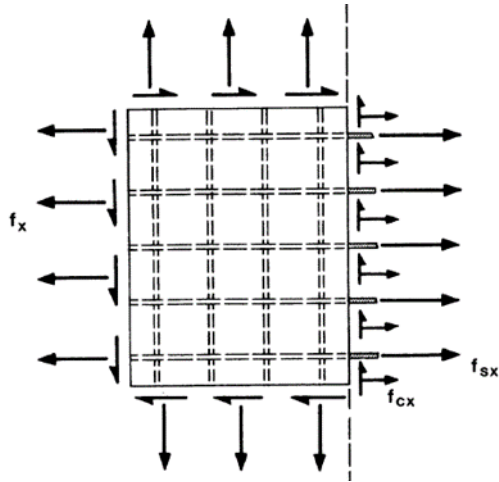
Painel fissurado de concreto armado (VECCHIO e COLLINS, 1986).
